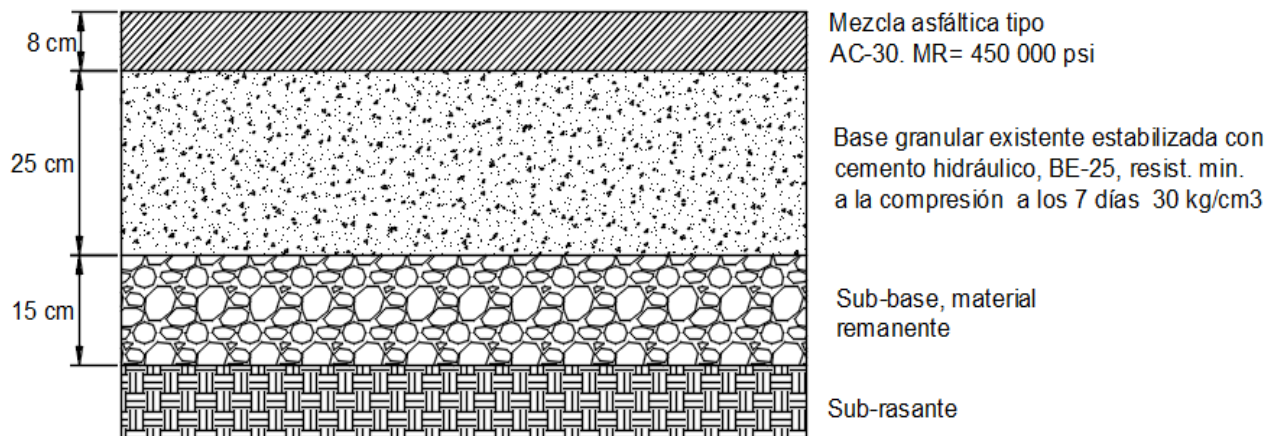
Perfil de la estructura de pavimento propuesta para el TH=1, P#1-P#3.
